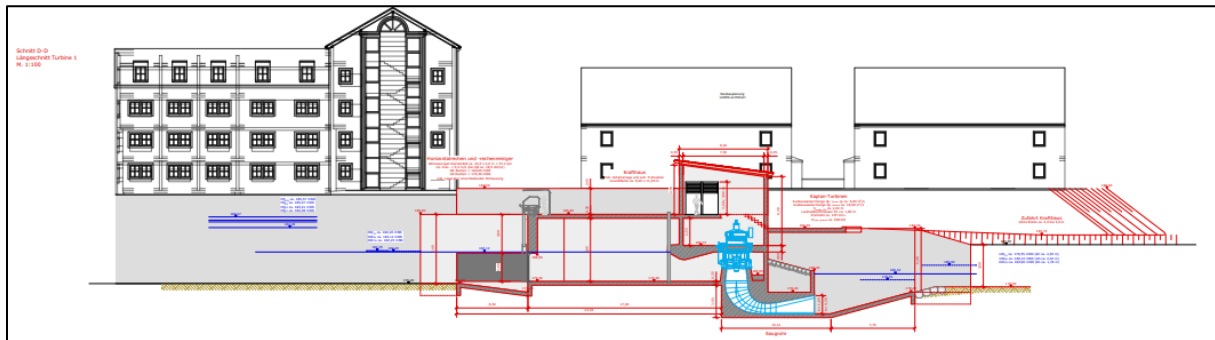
Bauwerkslängsschnitt mit Höhenvergleich zu den Bestandgebäuden [32].
